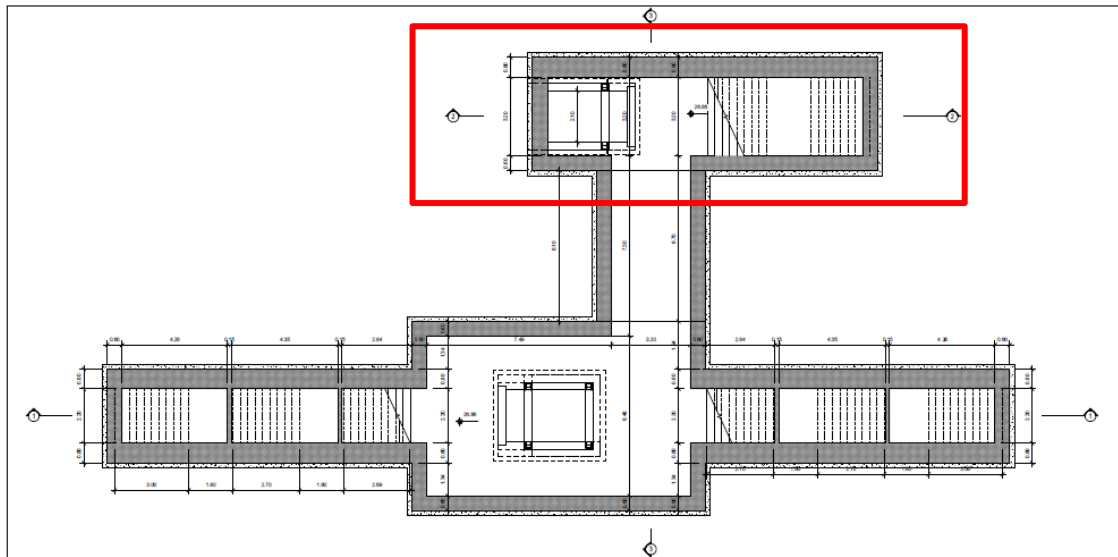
Planimetria dell’opera con individuazione del vano scala
